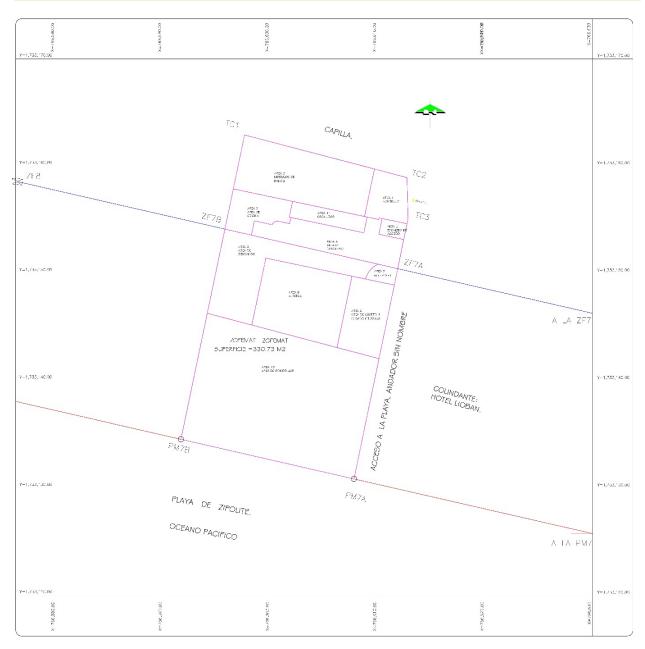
Plano de conjunto del Proyecto (Planta Baja)
